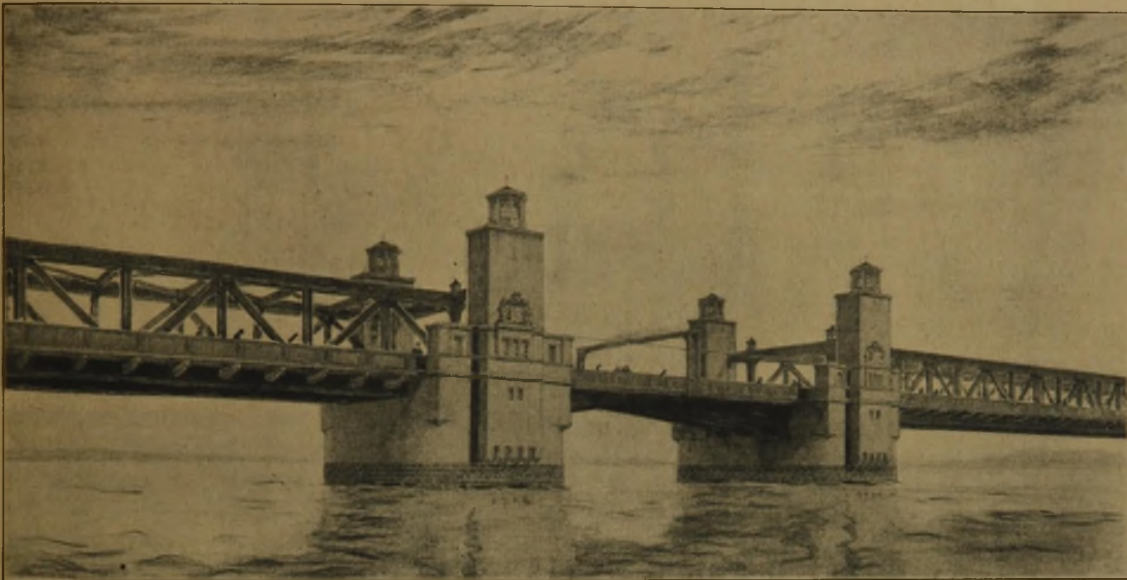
Entwurf mit dem Kennwort „Himmerland-Thy“. Ausführung in Eisen. Verfasser Carl Brandt, Hamburg (Brunnengründung System Reg.-Baumstr. A. H. Müller); A.-G. Lauchhammer und Architekt E. Rentsch, Berlin.
